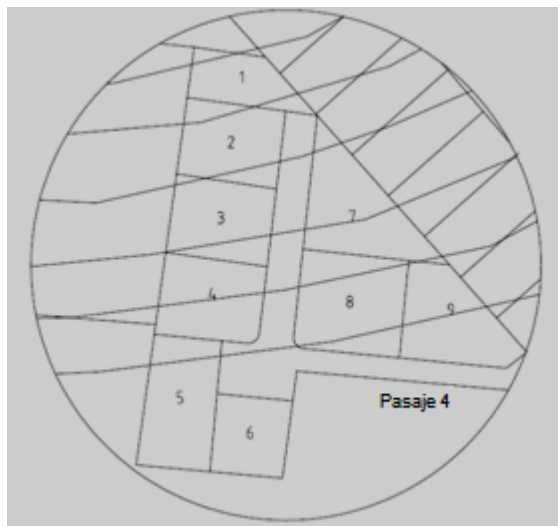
Zona de detalle al sur- oriente en la lotificación Santa Rosa
